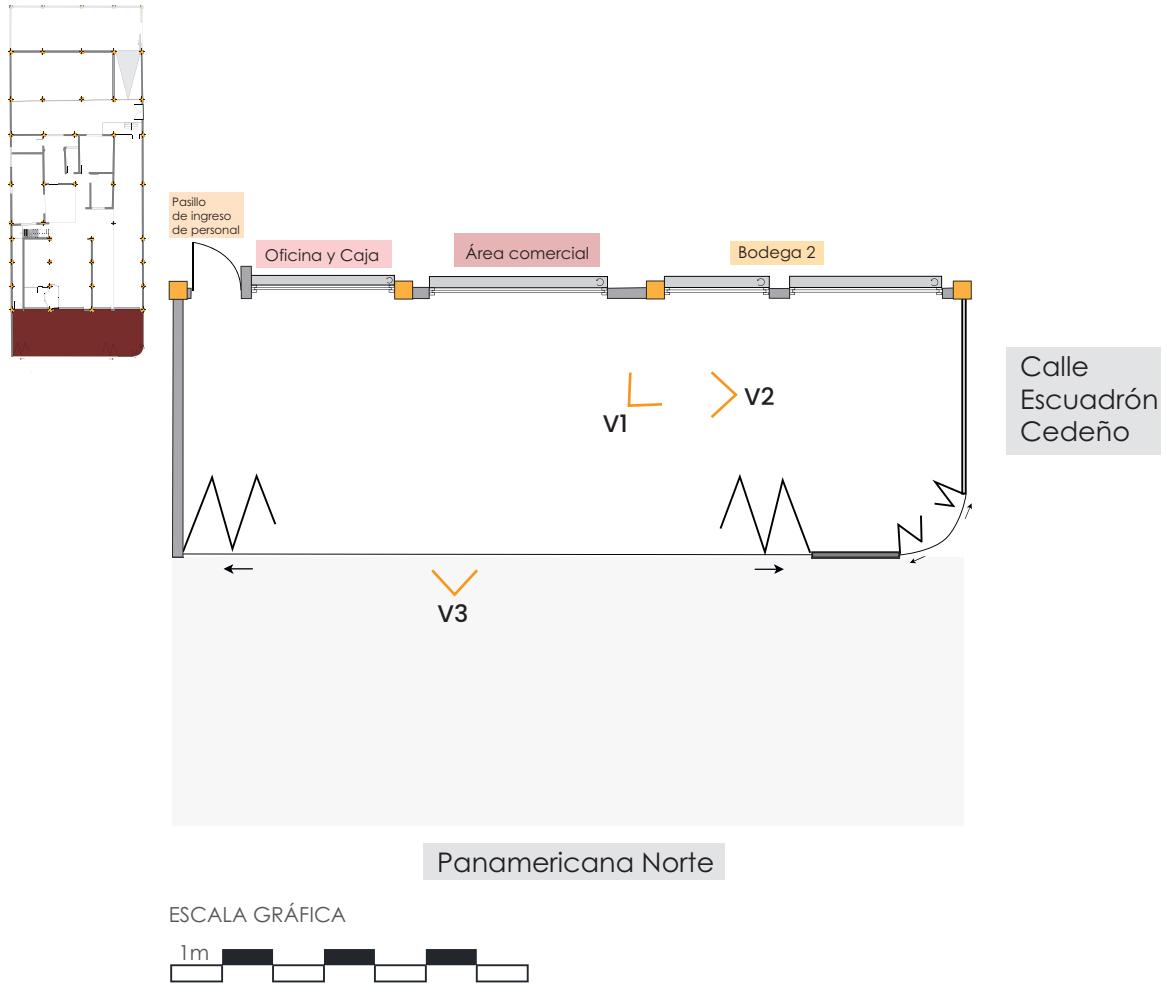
Ubicación en planta y planta detalle del retiro frontal y fachada.
